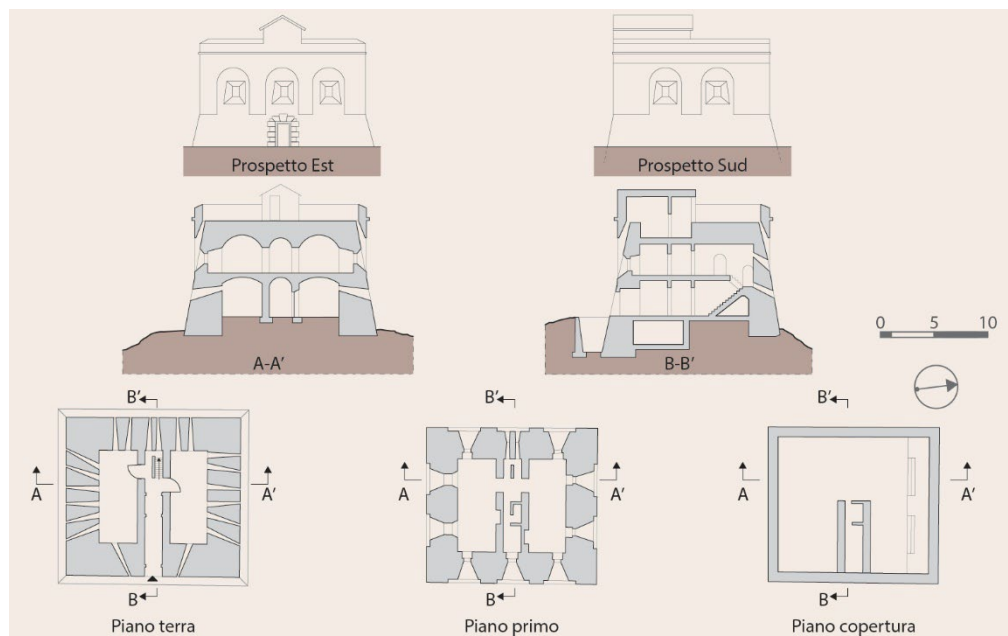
Pianta prospetti sezioni del Forte Maggiore (ridisegno degli autori da Finocchio, 1983).
